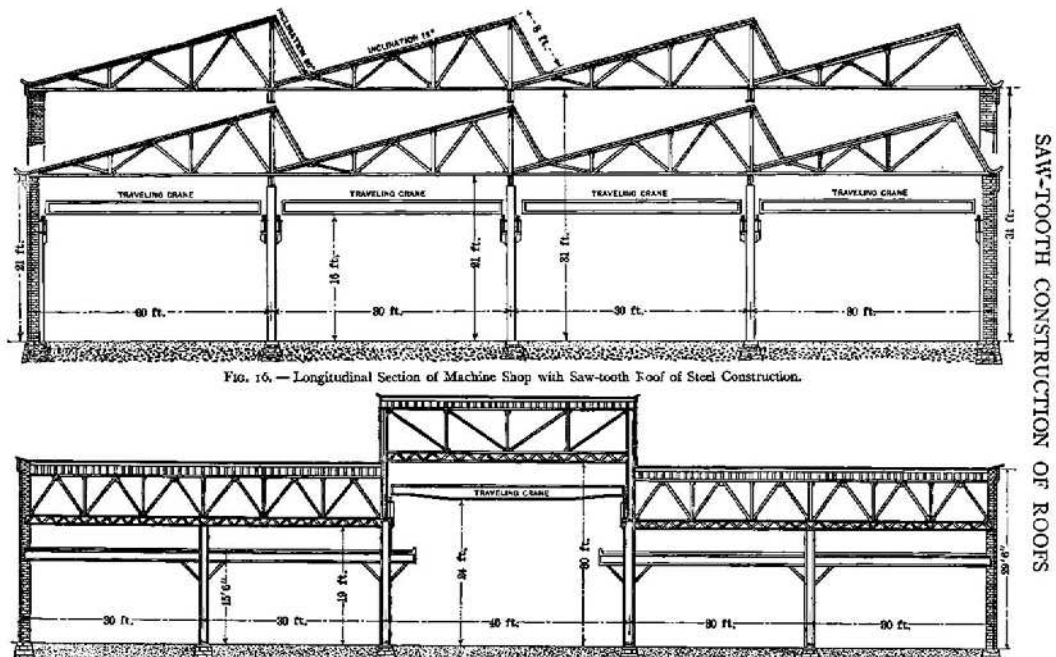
Saw-Tooth Construction Of Roofs.* Ilustración publicada por el ingeniero Oscar E. Perrigo en su libro *Modern Machine Shop Construction* (1906)
